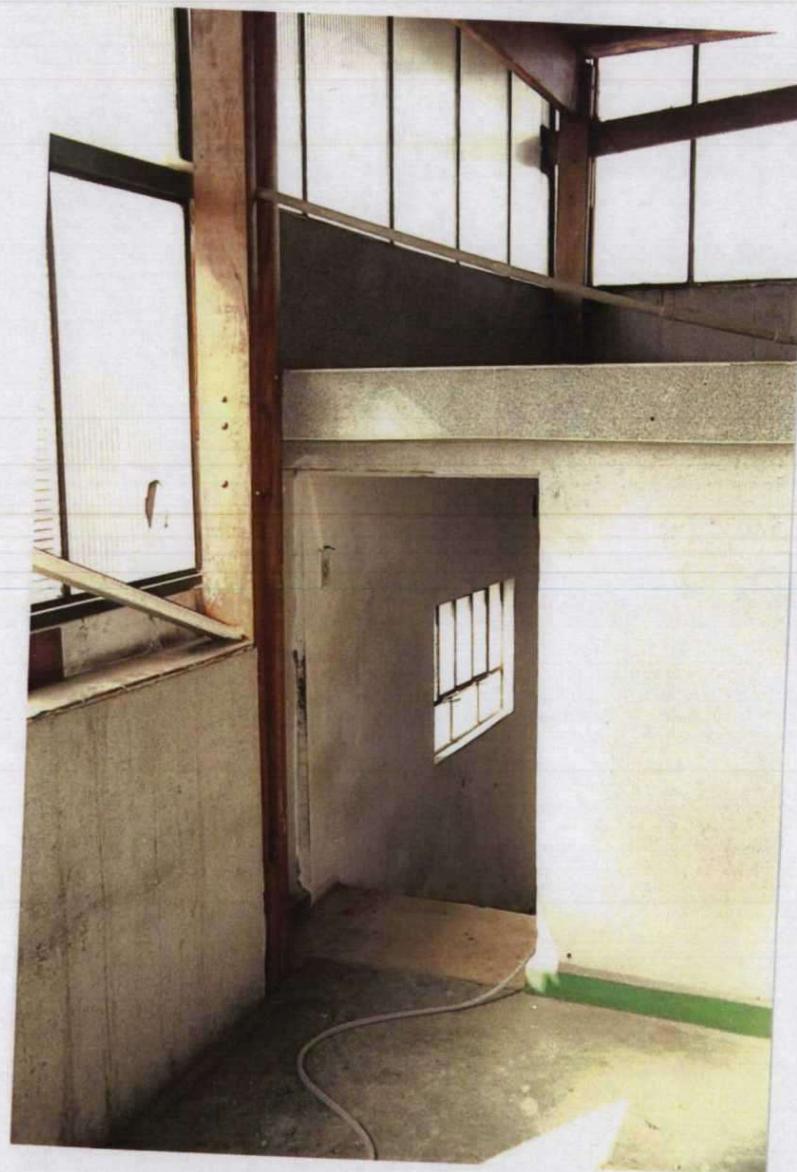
ACESSO A INSTALAÇÕES TÉCNICAS
